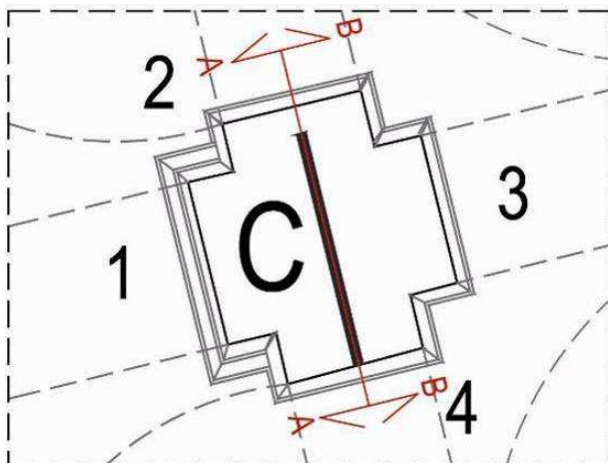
Localizzazione delle prove sul pilastro C.
